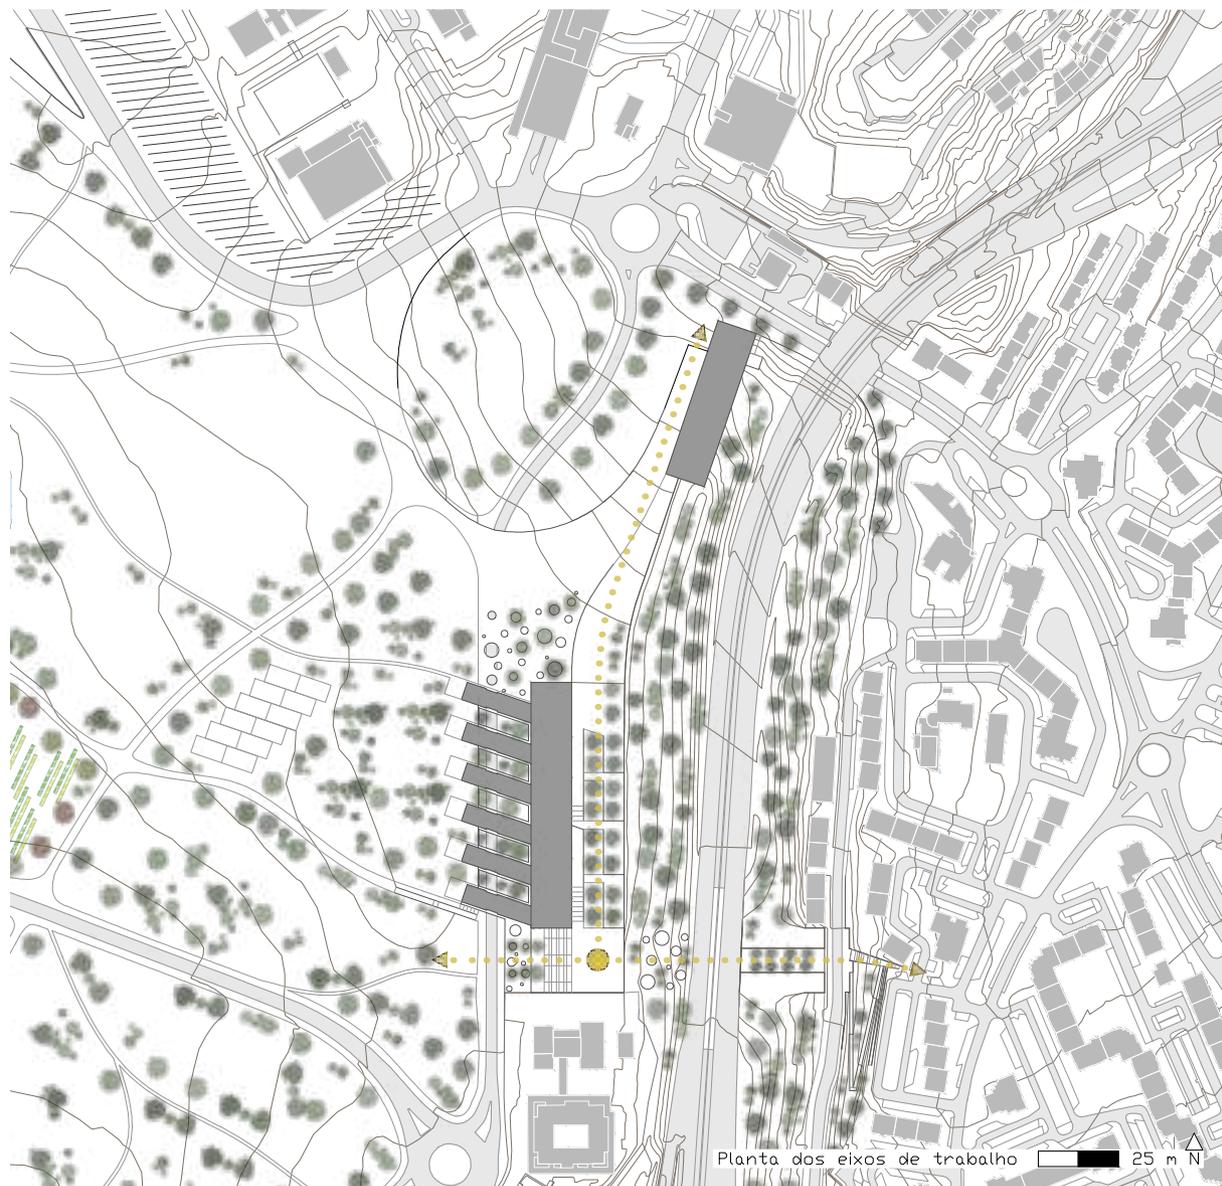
Planta dos eixos de trabalho (Fonte: Marco Andrade, 2019)
